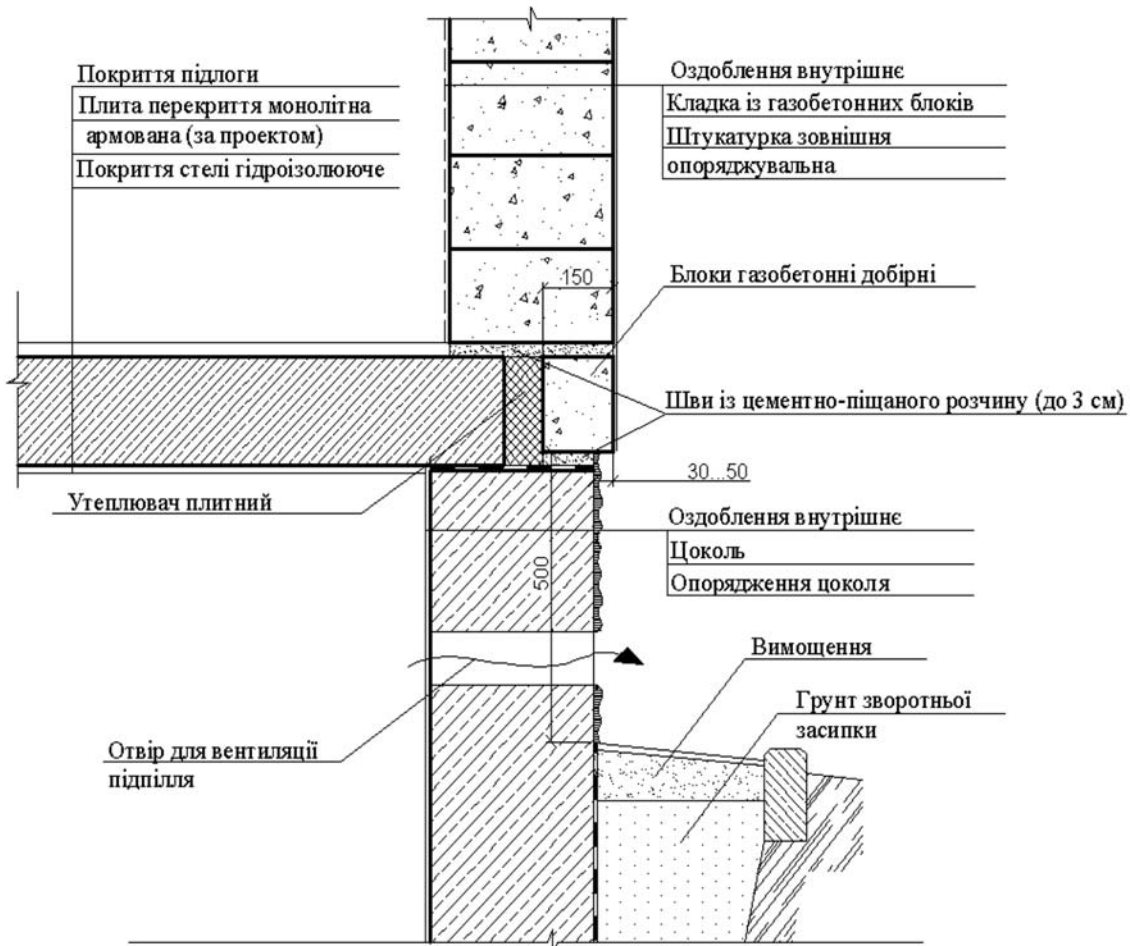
Вузол спирання газобетонної стіни із монолітного бетону на фундамент із монолітним перекриттям та підвалом
